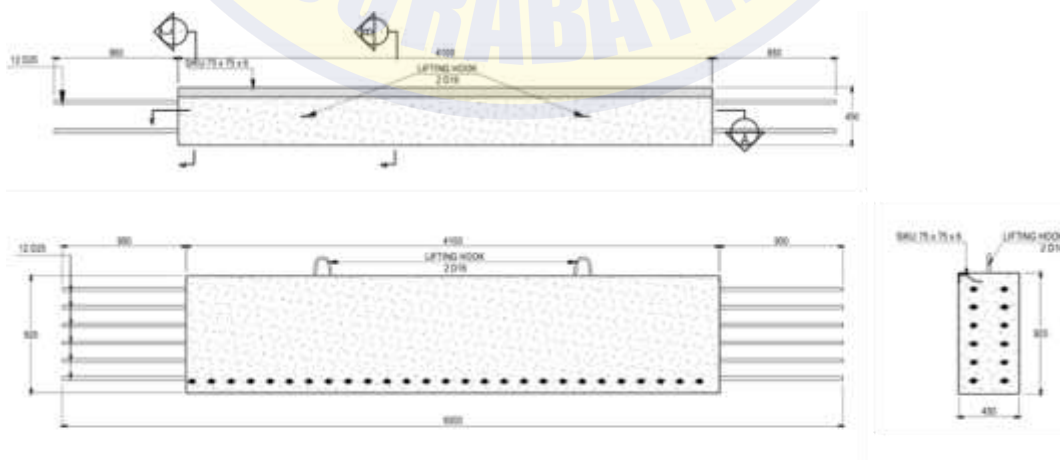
Contoh Modul Precast Tipe P1 Capping Beam
